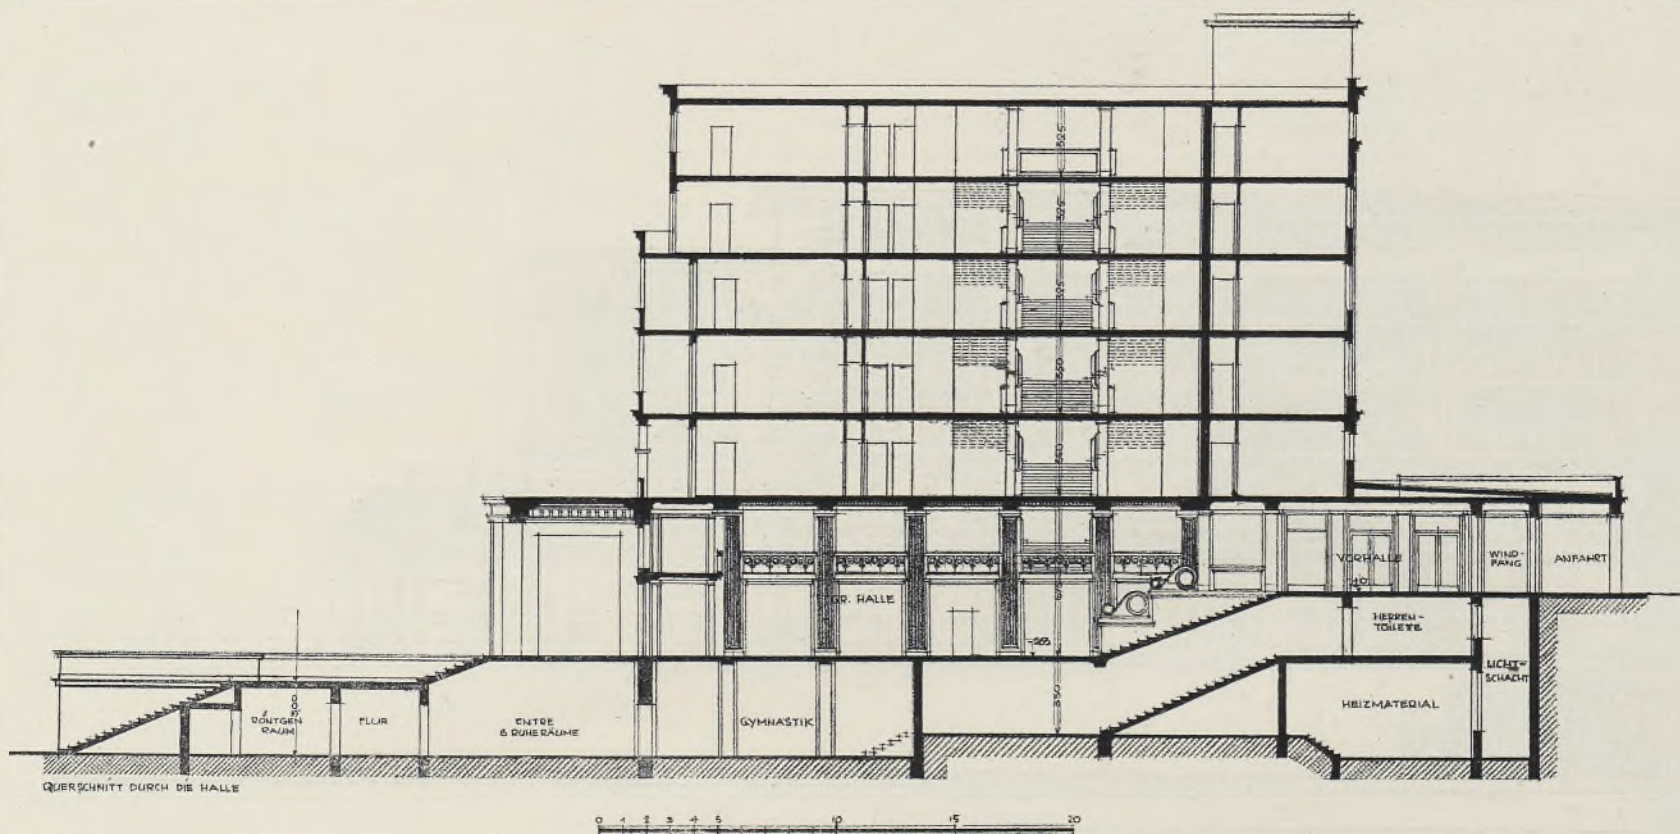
Peter Behrens, Hotelprojekt, Querschnitt durch die Halle.
